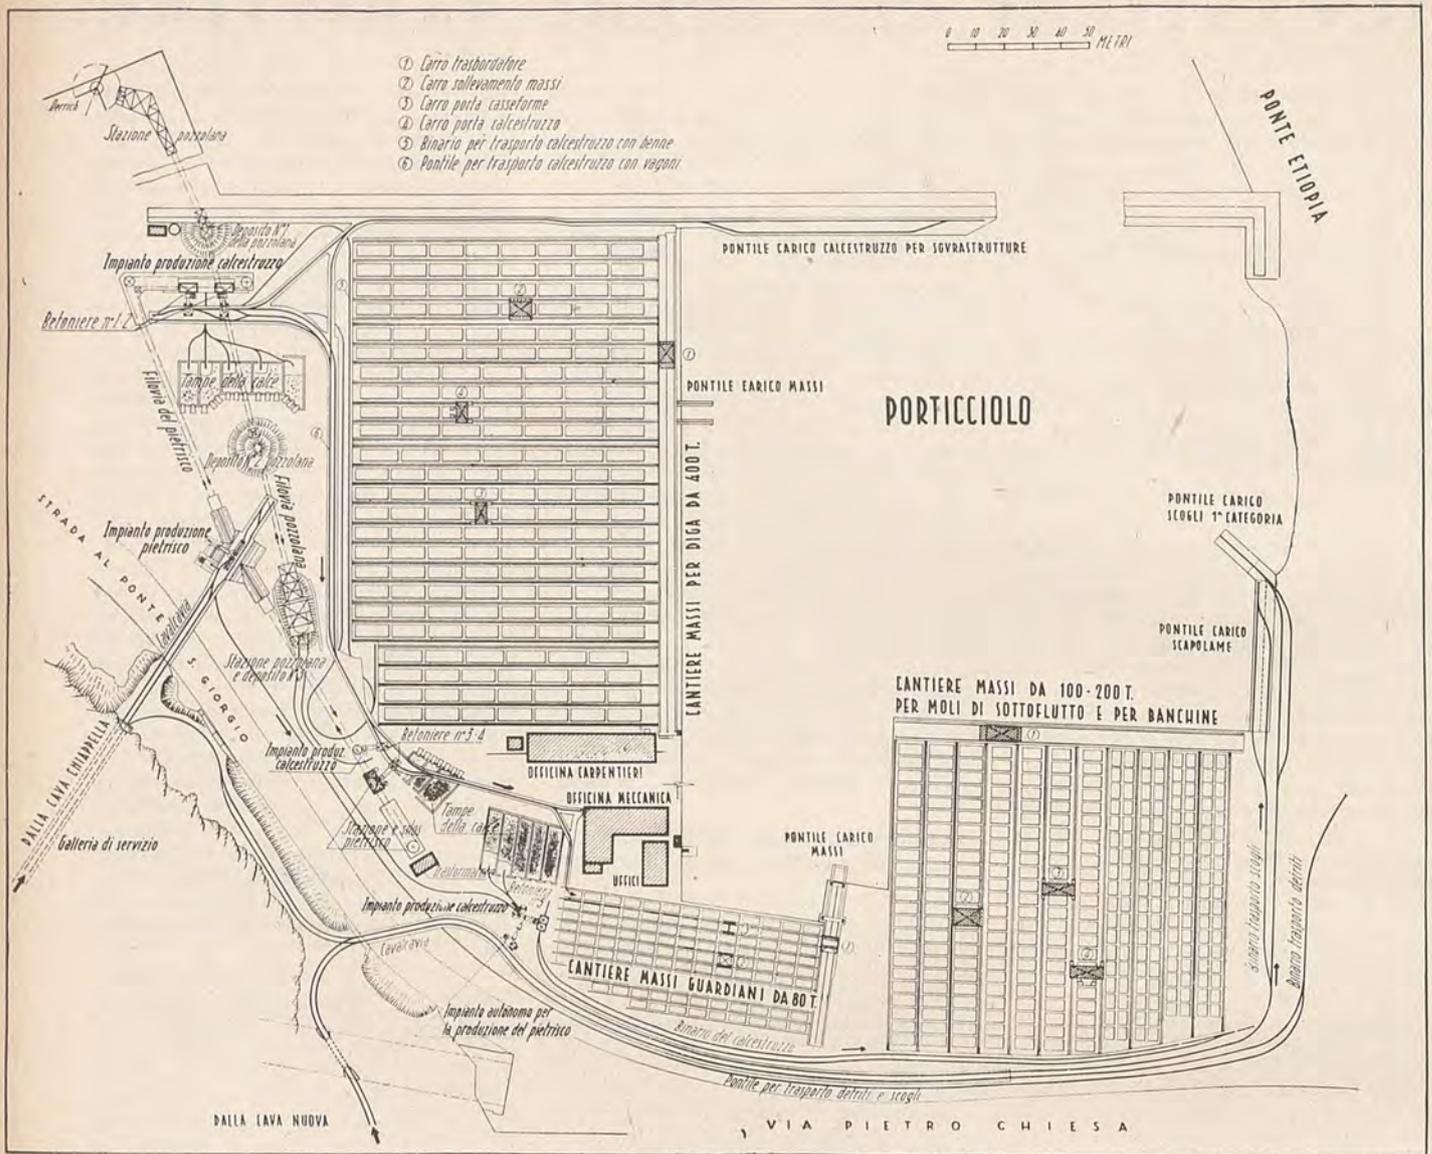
Planimetria Cantiere « FINCOSIT » nel Porto di Genova.
